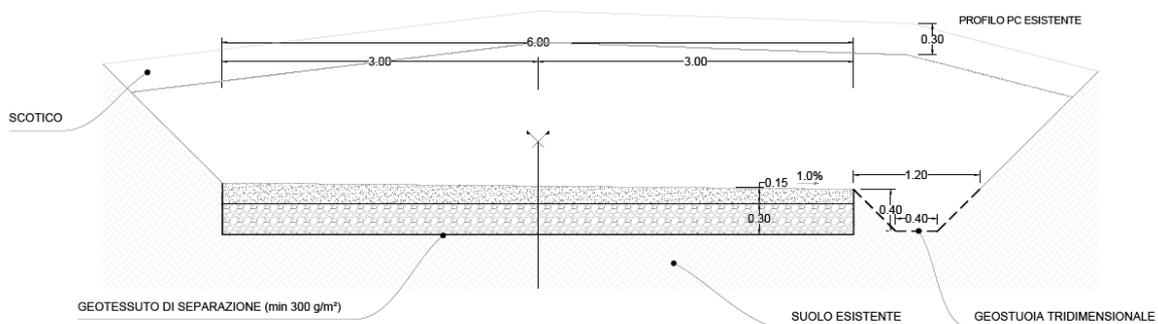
Sezione trasversale viabilità di nuova realizzazione. Fonte: elaborato di progetto "C21BLN001CWD01901_Tipico sezione stradale con particolari costruttivi"
